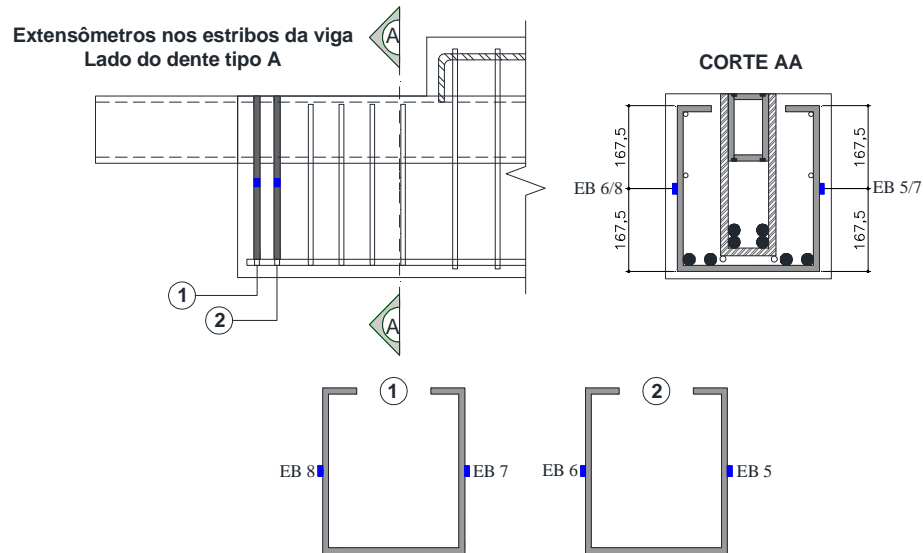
Posicionamento dos extensômetros nos estribos da viga – dente-7,5 (ver detalhe completo na Figura 3.34)
